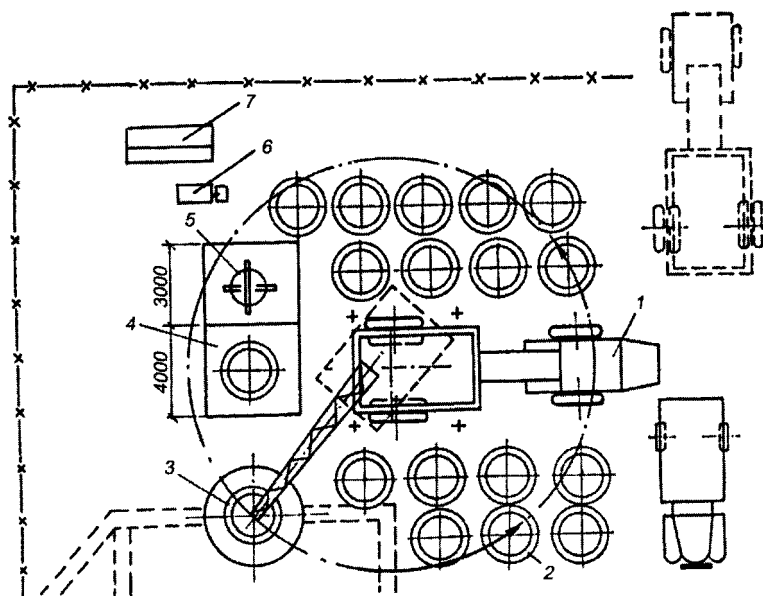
Схема организации работ по монтажу сборной трубы стреловым краном: 1 - монтажный кран; 2 - приобъектный склад царг; 3 - фундамент трубы; 4 - площадка подготовки царг к монтажу; 5 - площадка для монтажного оборудования; 6 - растворосмеситель; 7 - ларь
